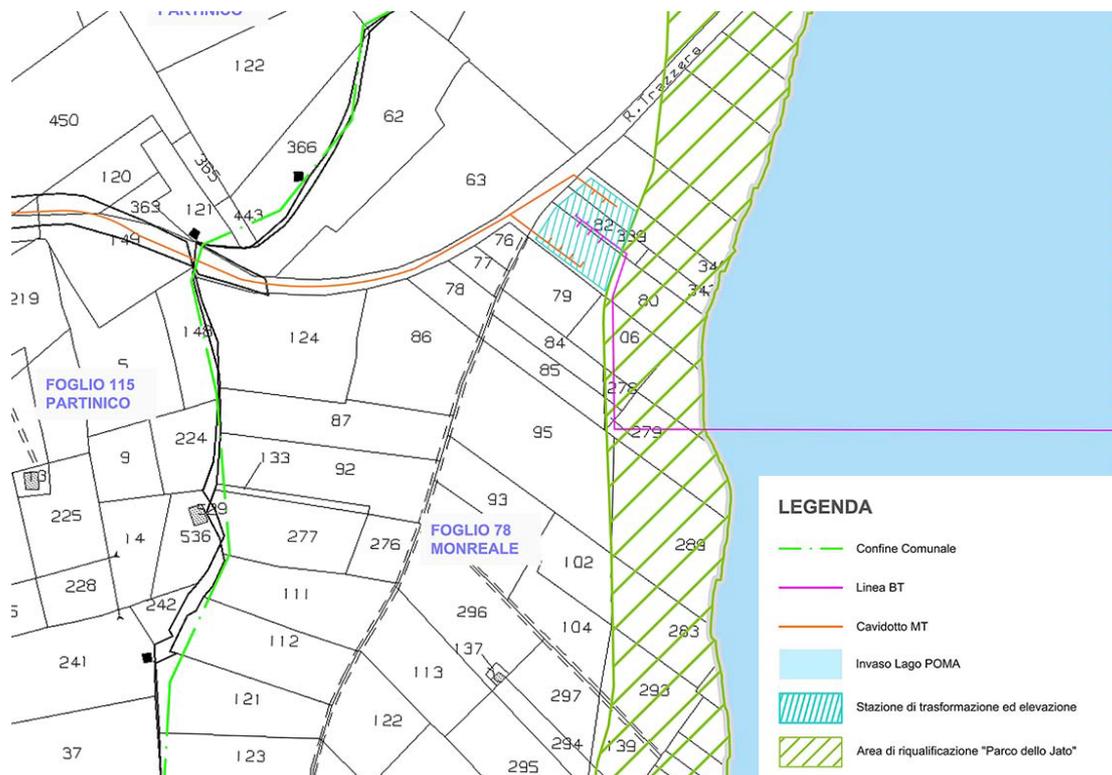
B – Layout della stazione di trasformazione ed elevazione con cavidotto
